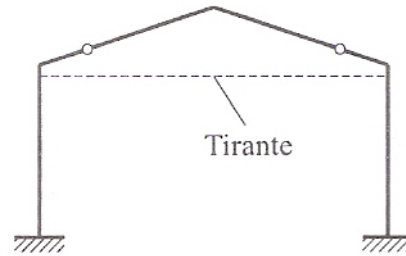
Sistema aporticado com elementos engastados na fundação e duas articulações na travessa. Fonte: EL DEBS (2000).
